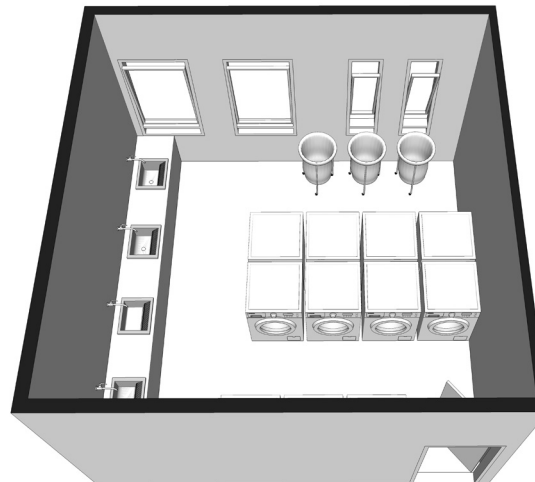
Dimensionamento e layout propositivo da lavanderia.
